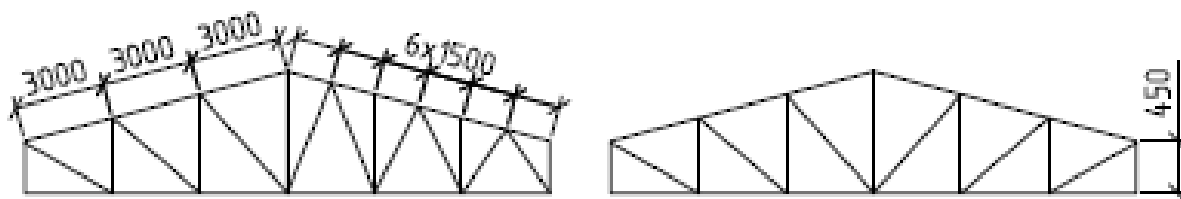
Высота фермы на опоре у треугольной фермы, шпренгельные решетки
